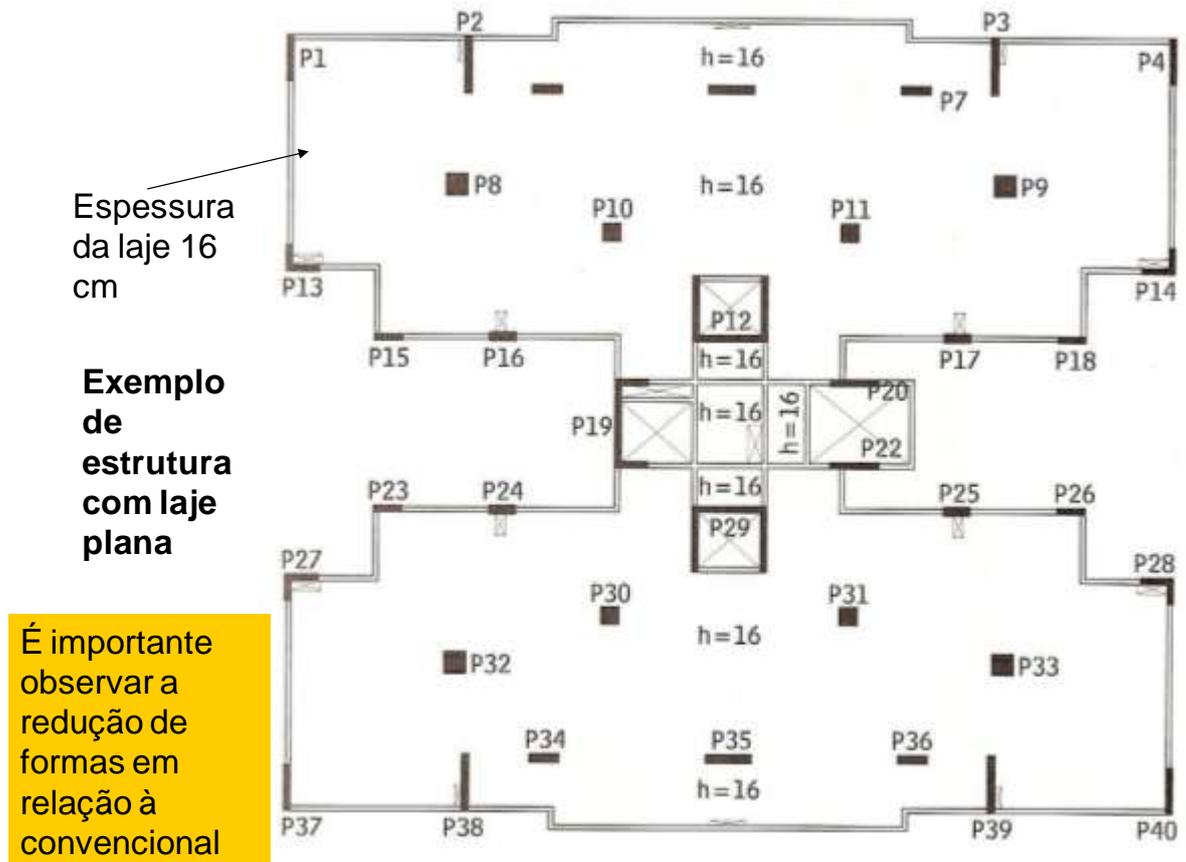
Planta de fôrma no sistema de lajes planas (VARGAS, 2008).
